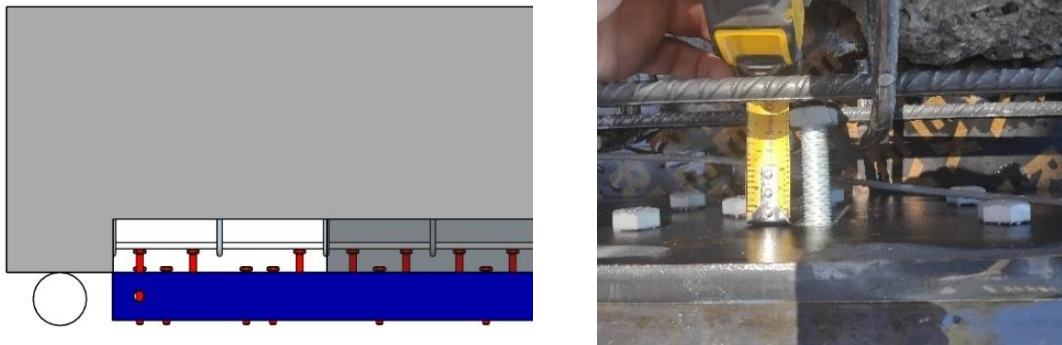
Vista de conectores dispuestos en recubrimiento de la viga. La cabeza del conector queda a cota con el estribo.
